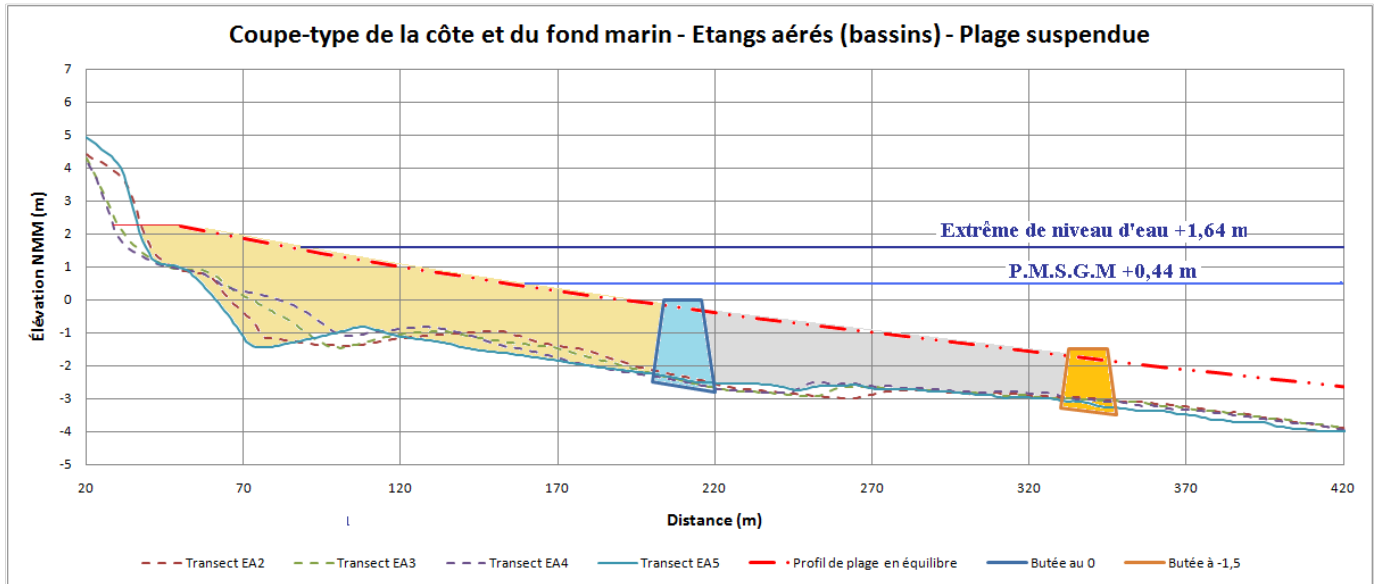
Coupe type d'une plage suspendue devant les étangs aérés
